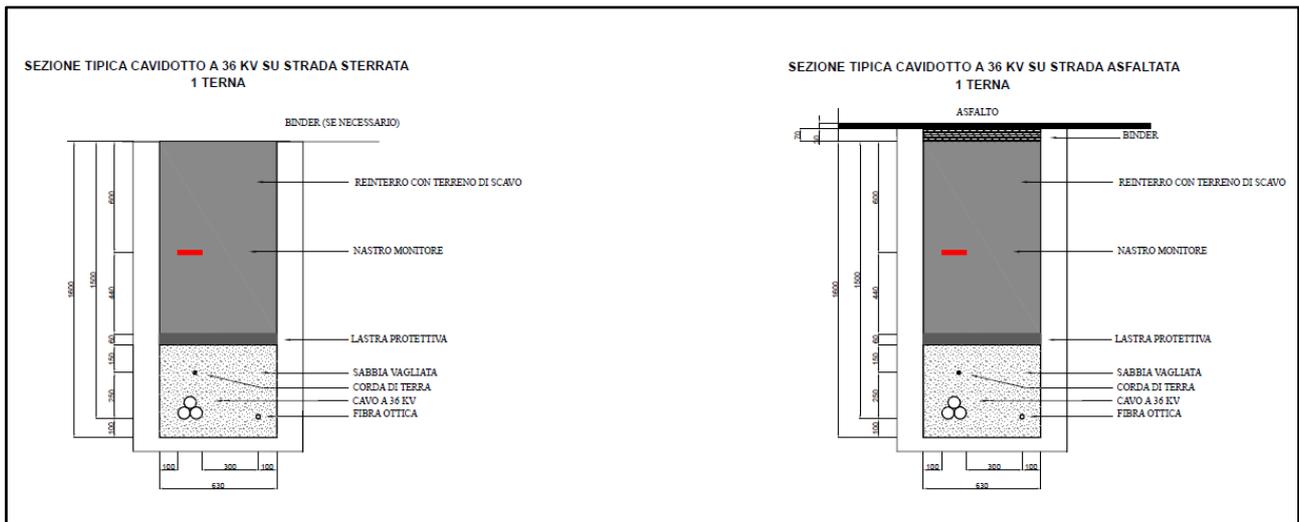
Sezioni tipiche delle trincee cavidotto per una terna di cavi in parallelo
